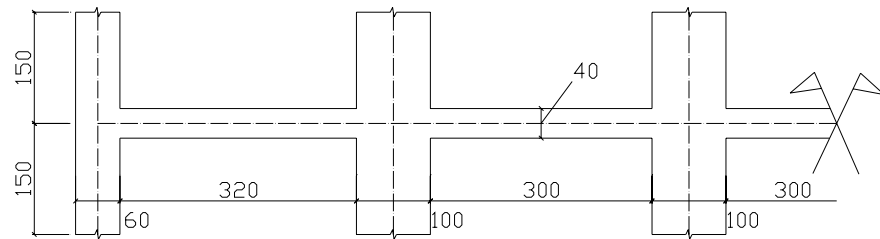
Geometria da viga, Caso 9 (dimensões em cm)
